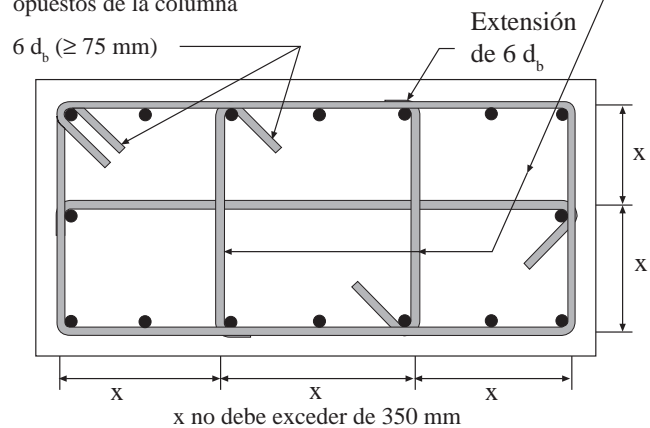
Ejemplo de armadura transversal en columnas
